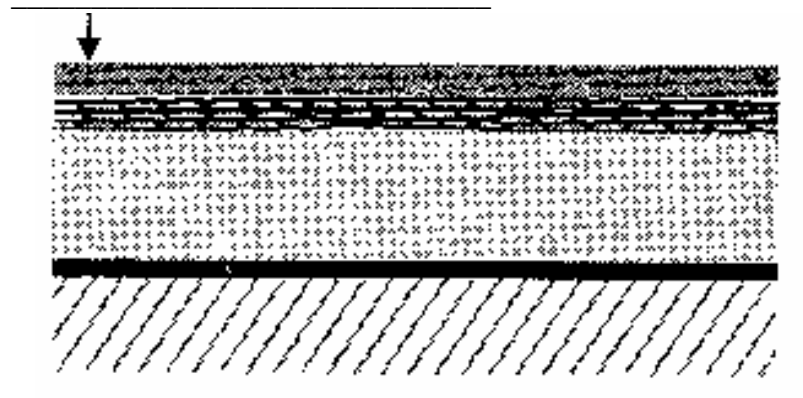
Конструкция кровли с применением экструдированного пенополистирола
